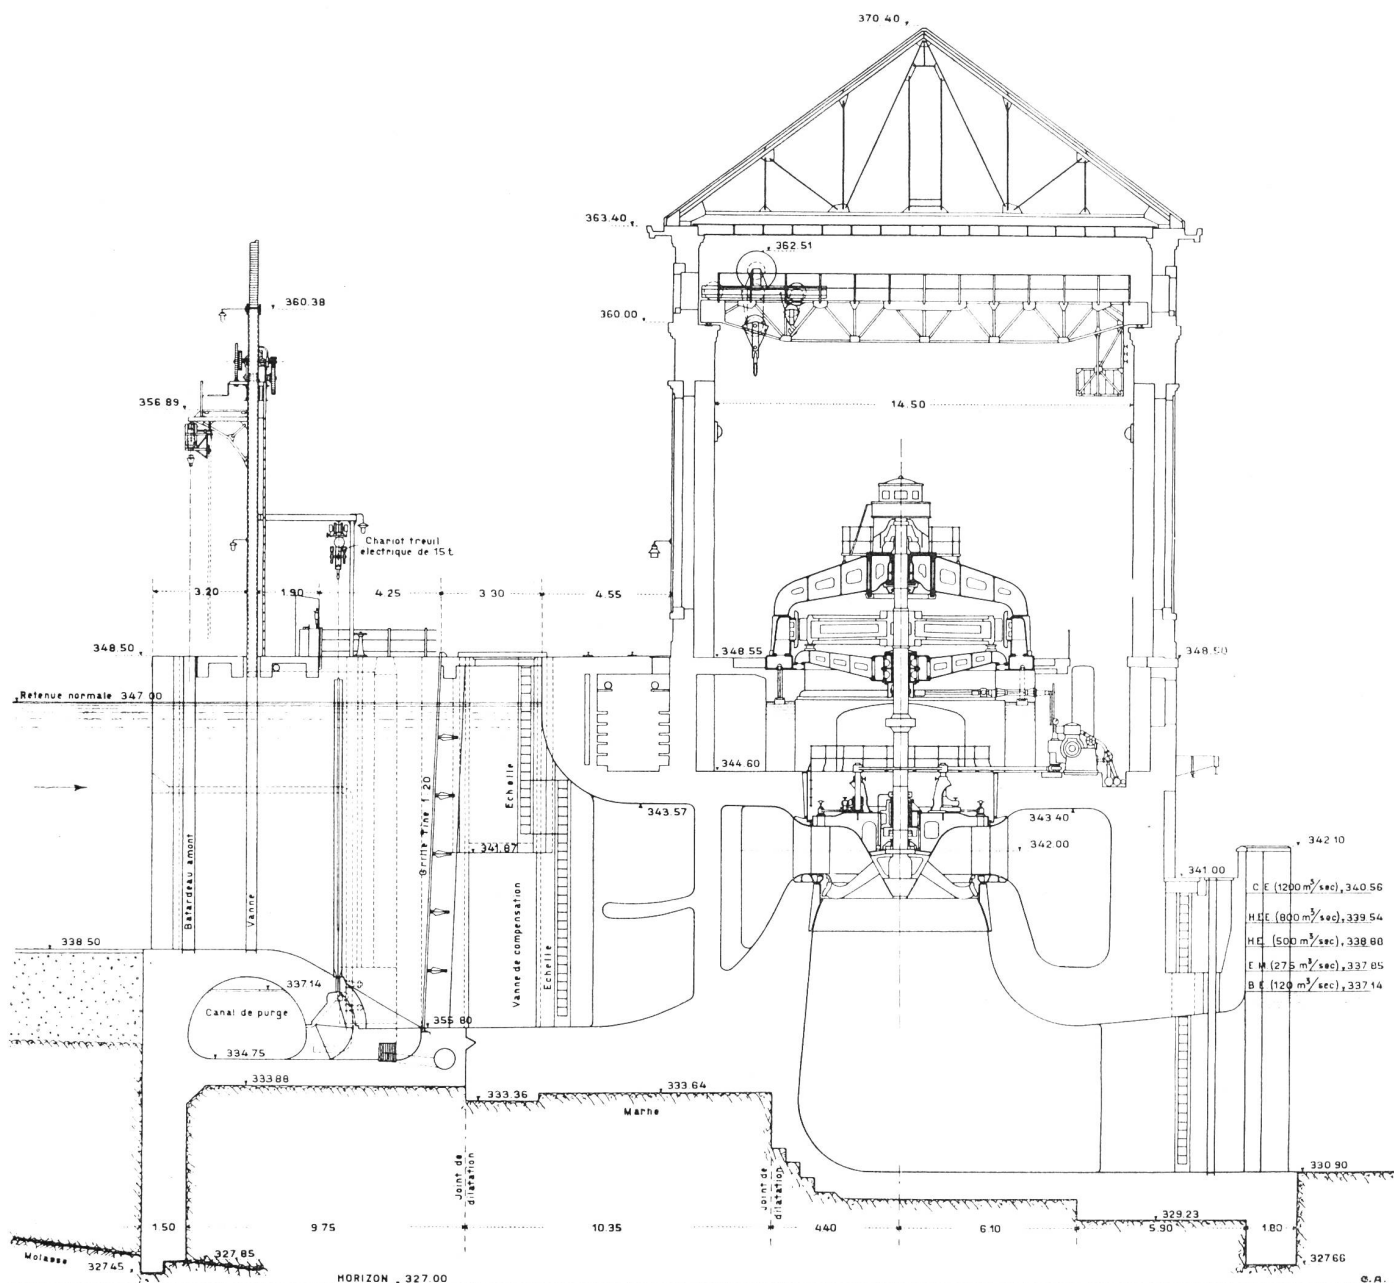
Chancy-Pougny. Querschnitt durch die Turbine 4 (Type Charmilles). Maßstab 1: 250.
